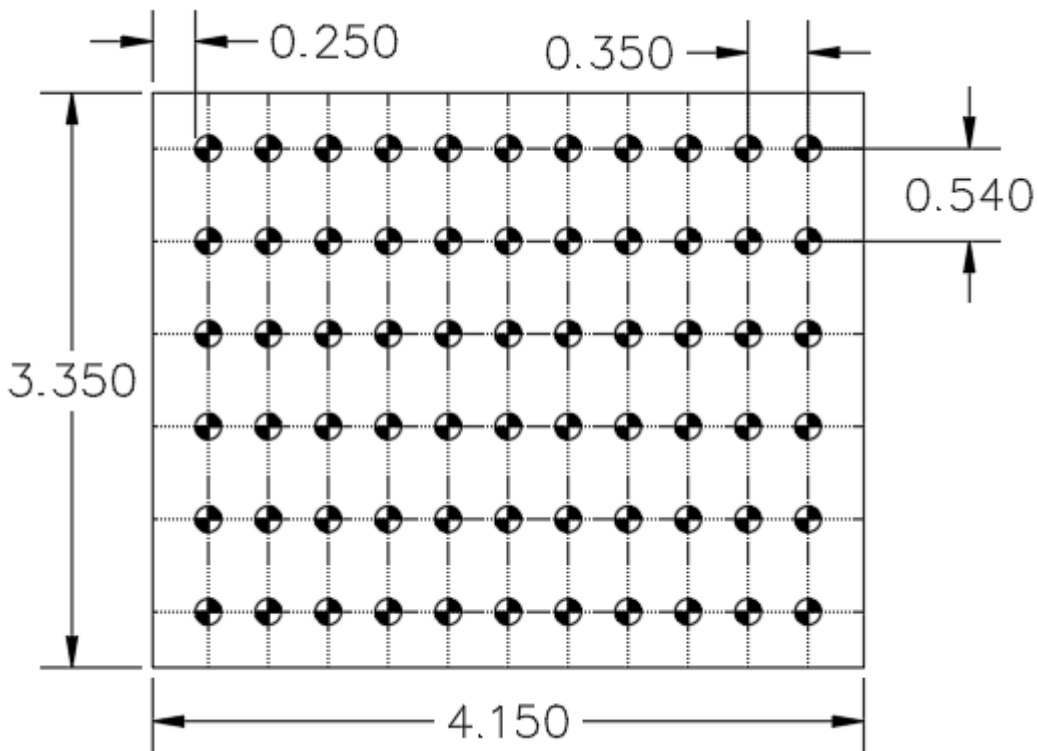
Predimensionamiento del encepado N1246 con pilar articulado
